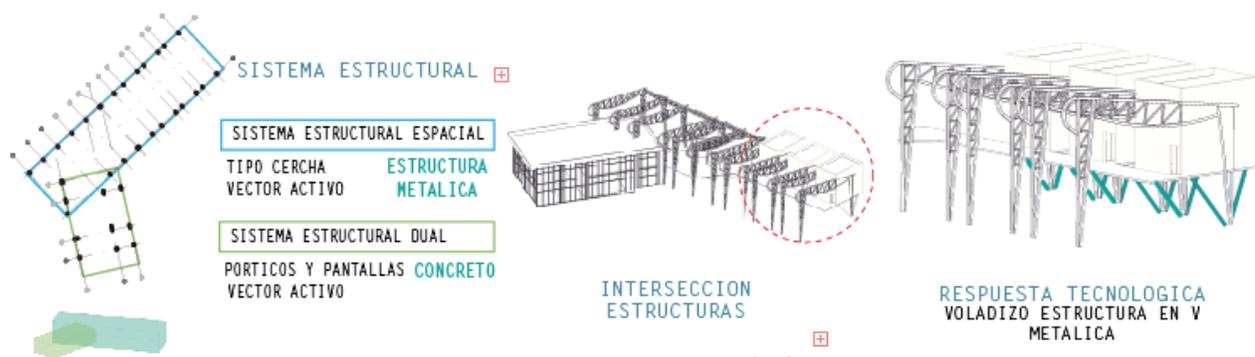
Sistemas estructurales e intersecciones de estructuras Fuente: Elaboración propia 2018©
